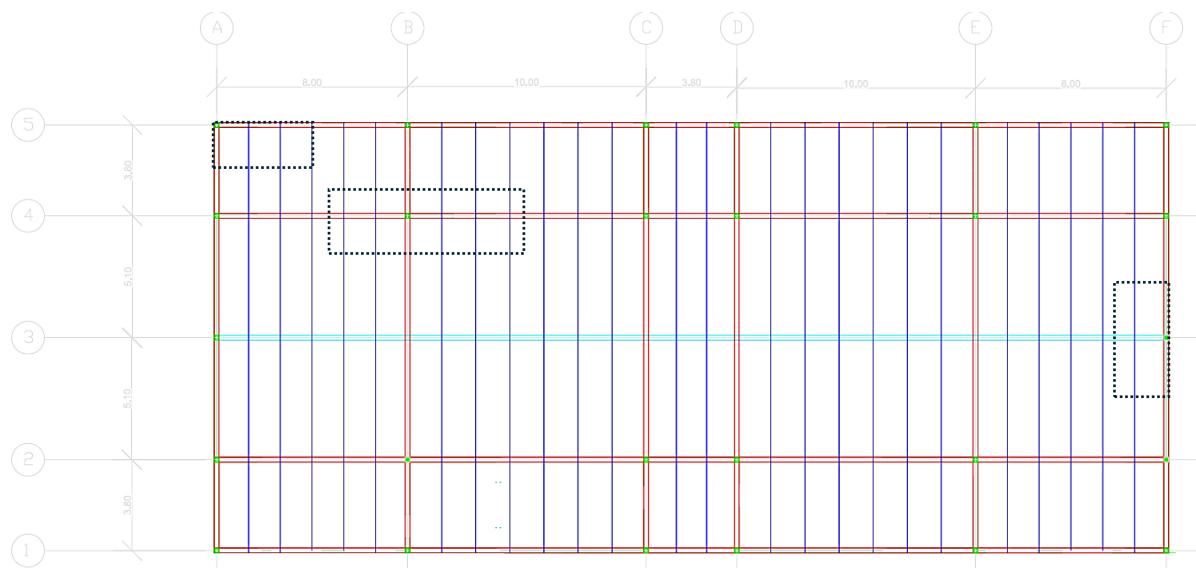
Esquema de áreas colaborante de columnas- .
